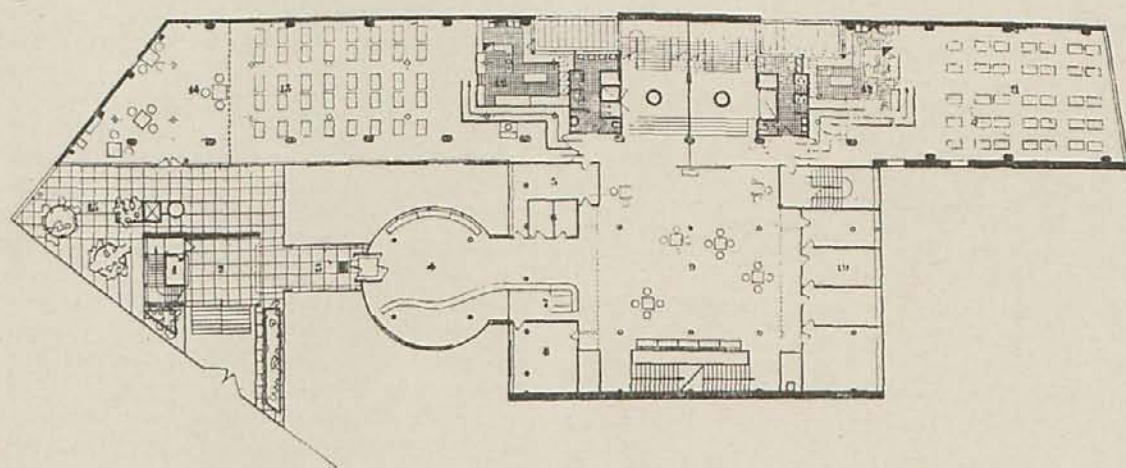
Ciudad de refugio, París 1932-33. Planta al nivel del pórtico de entrada del vestíbulo y los comedores.
